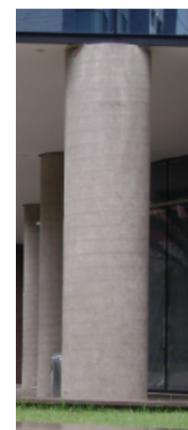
Pilar de 7 metros em concreto armado de seção transversal circular, encontrado em um edifício na avenida Norte-Sul em Campinas.
